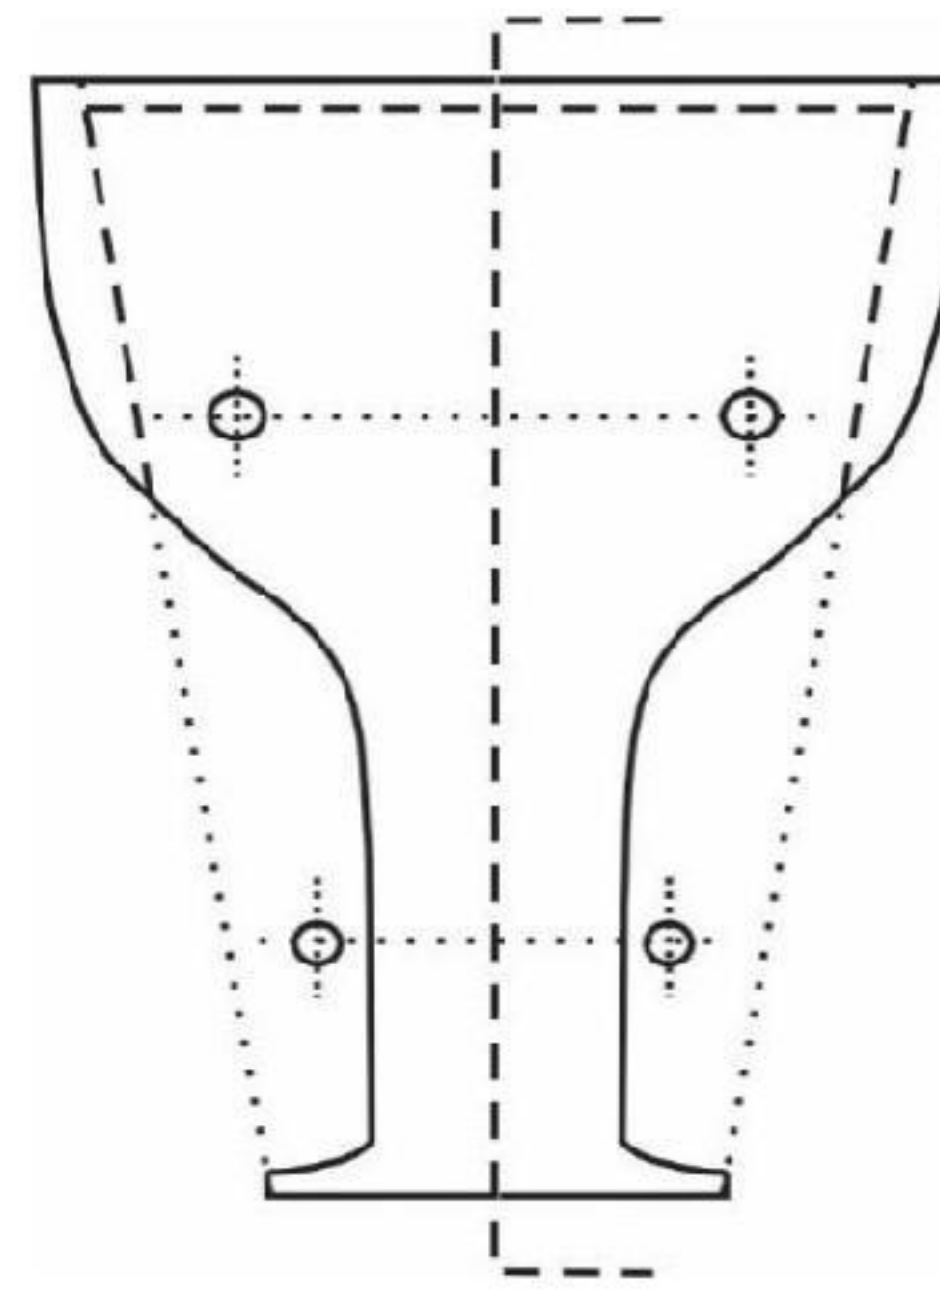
Kloset duduk tegak dipasang di lantai
